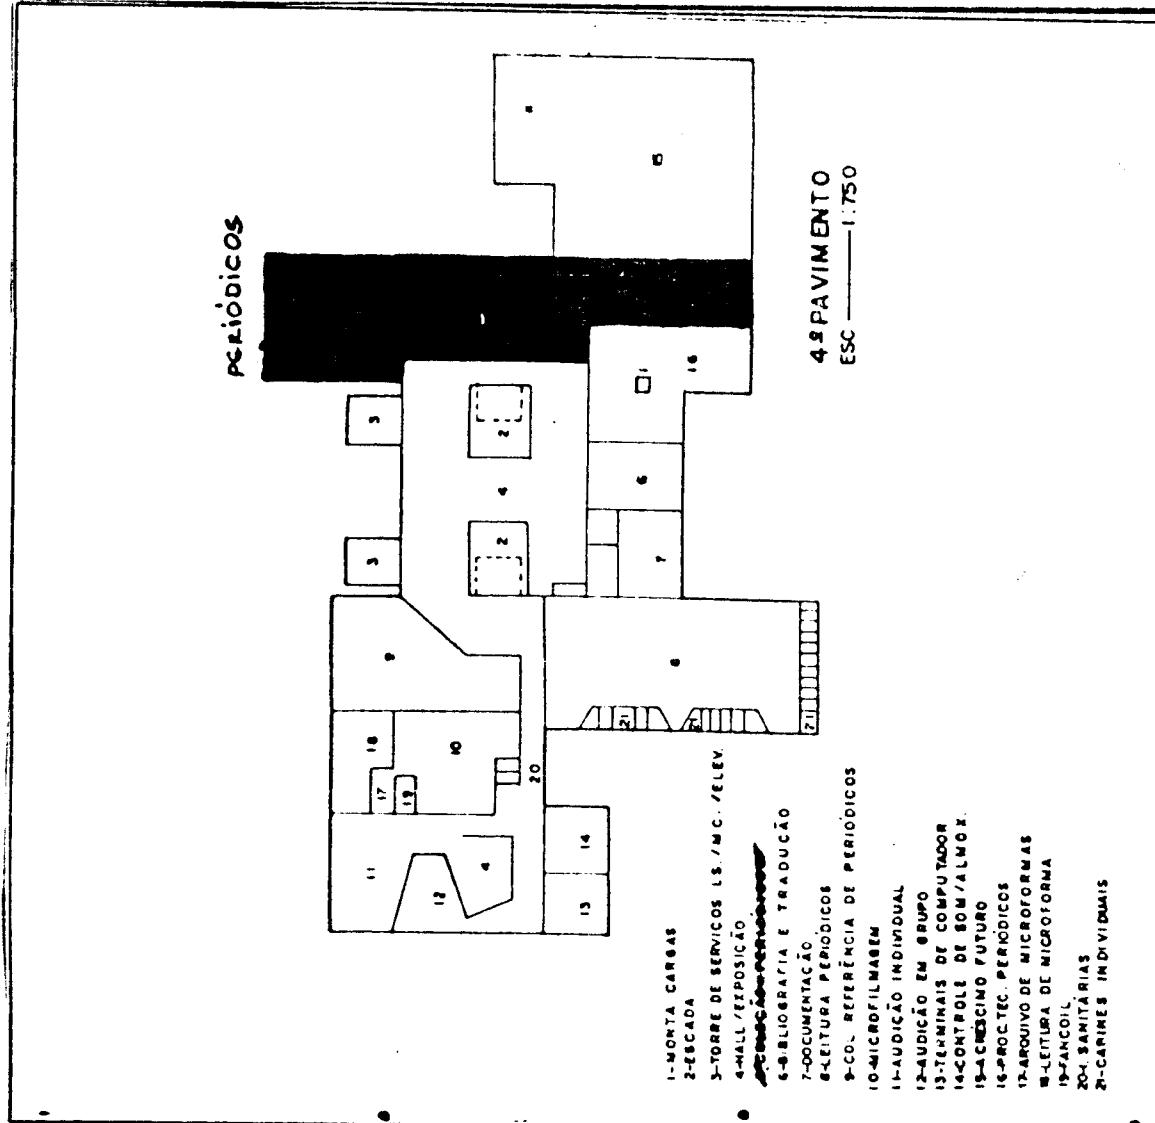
Projeto de construção do prédio da Biblioteca central - 4º pavimento
